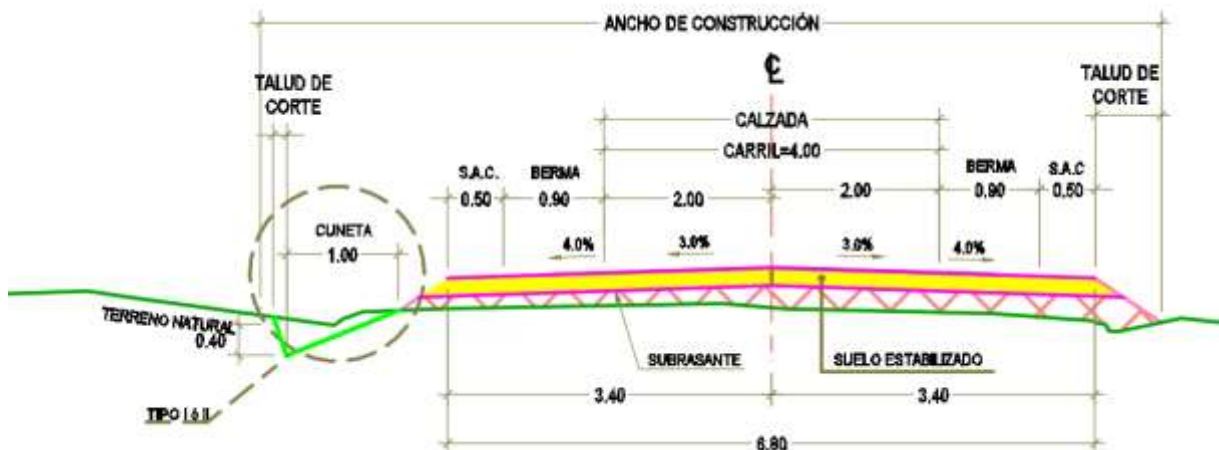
Sección típica particular con cuneta baja. Fuente: Plano de secciones típicas.
